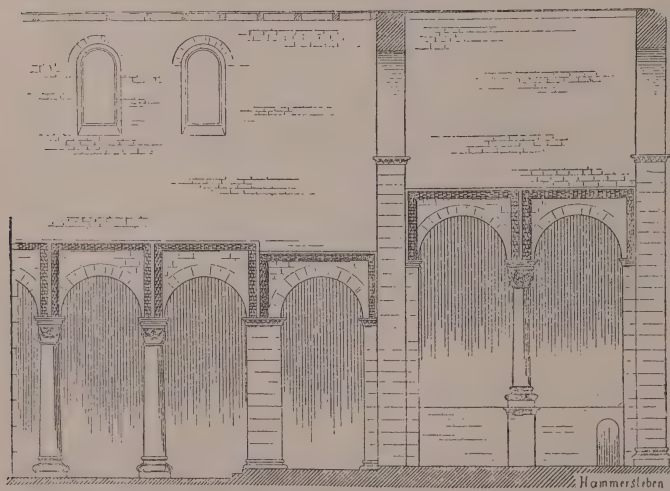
Disposizione dei pilastri ad Hamersleben. (Dehio e v. Bezold).
